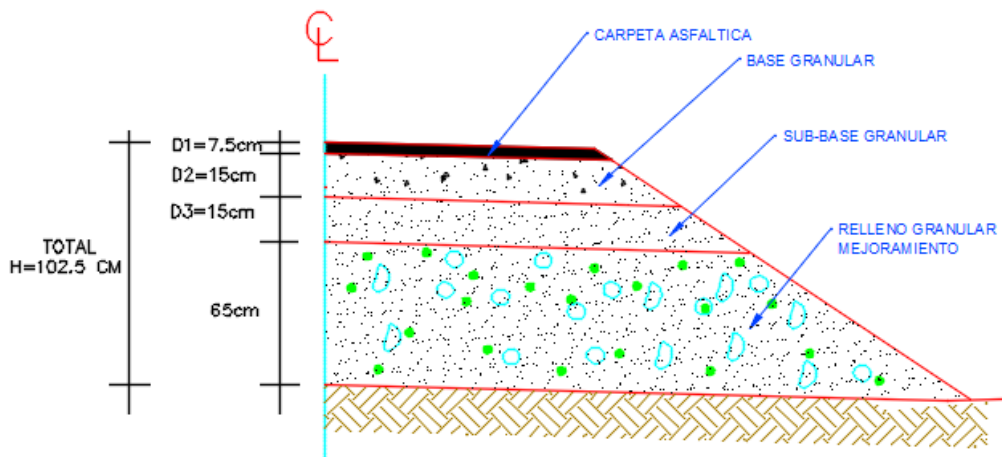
Paquete Estructural Obtenido sin Refuerzo de Geomalla
